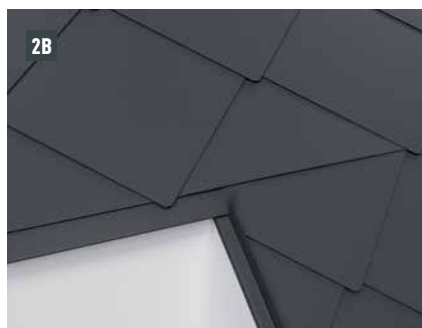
• Formowanie występu dachu – dachówka łupkowa i dachówka DS.19
